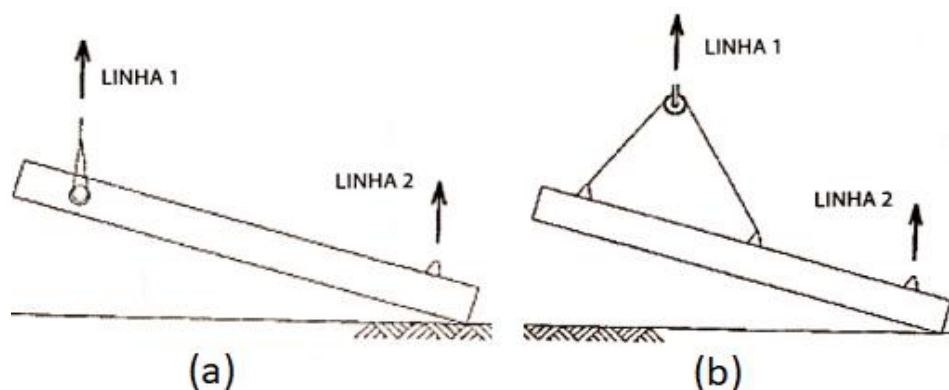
Exemplo de dispositivo auxiliar de montagem: (a) Içamento com o dispositivo; (b) Montagem com o dispositivo fixado.
